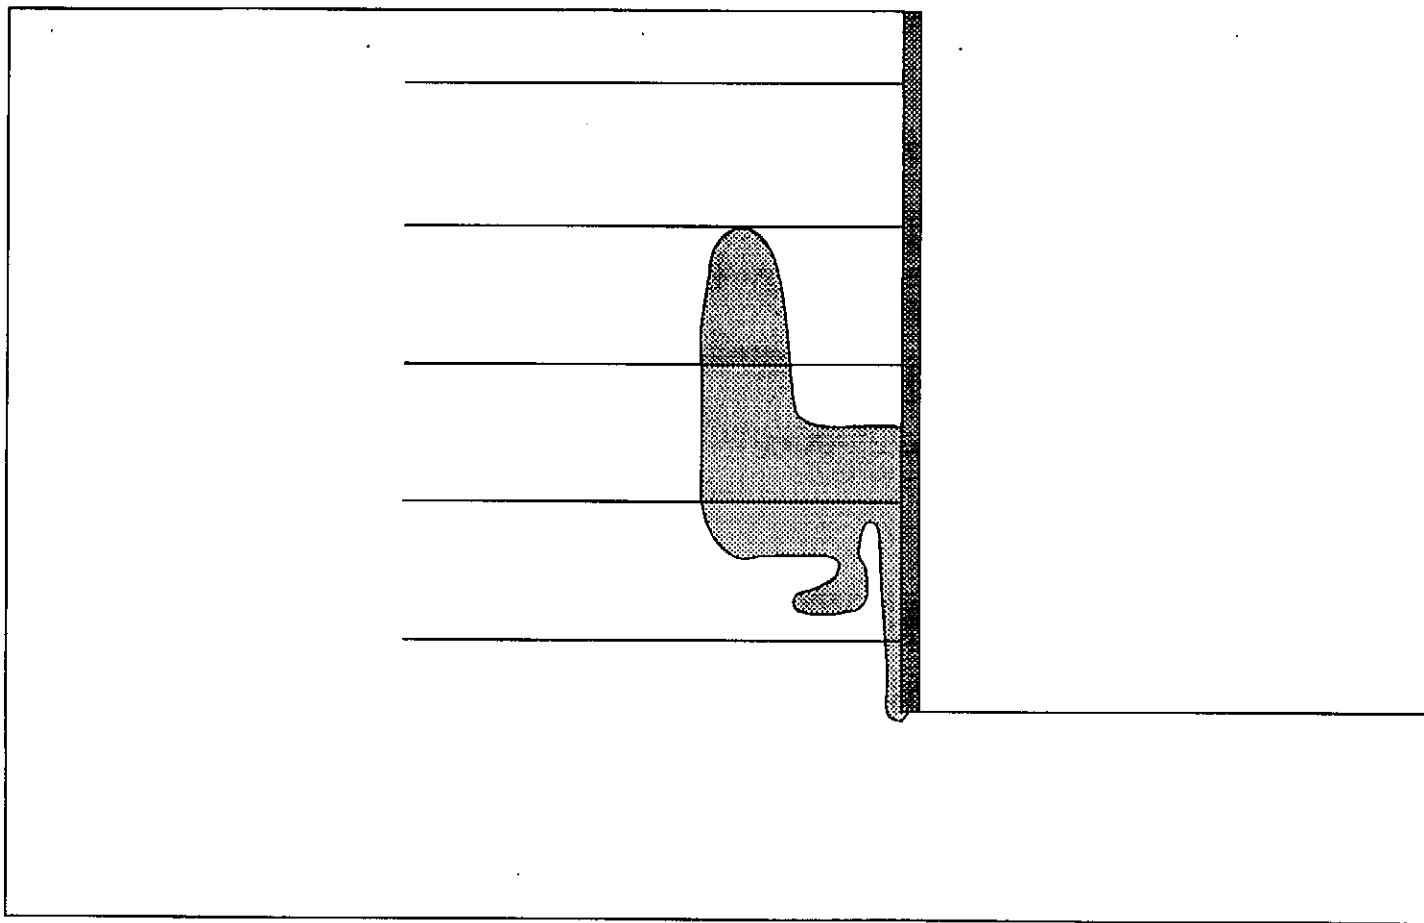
ESCAVAÇÃO COM REFORÇO HORIZONTAL
